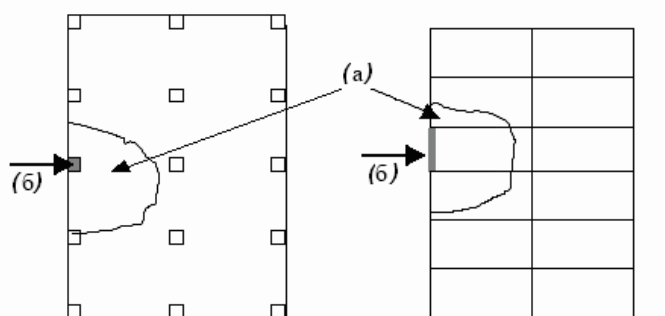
К пояснению пределов допустимого ущерба: (а) – не более меньшего из следующих двух значений: 15% или 100 м² площади перекрытия на каждом из двух смежных этажей; (б) – колонна, которая условно исключается.
